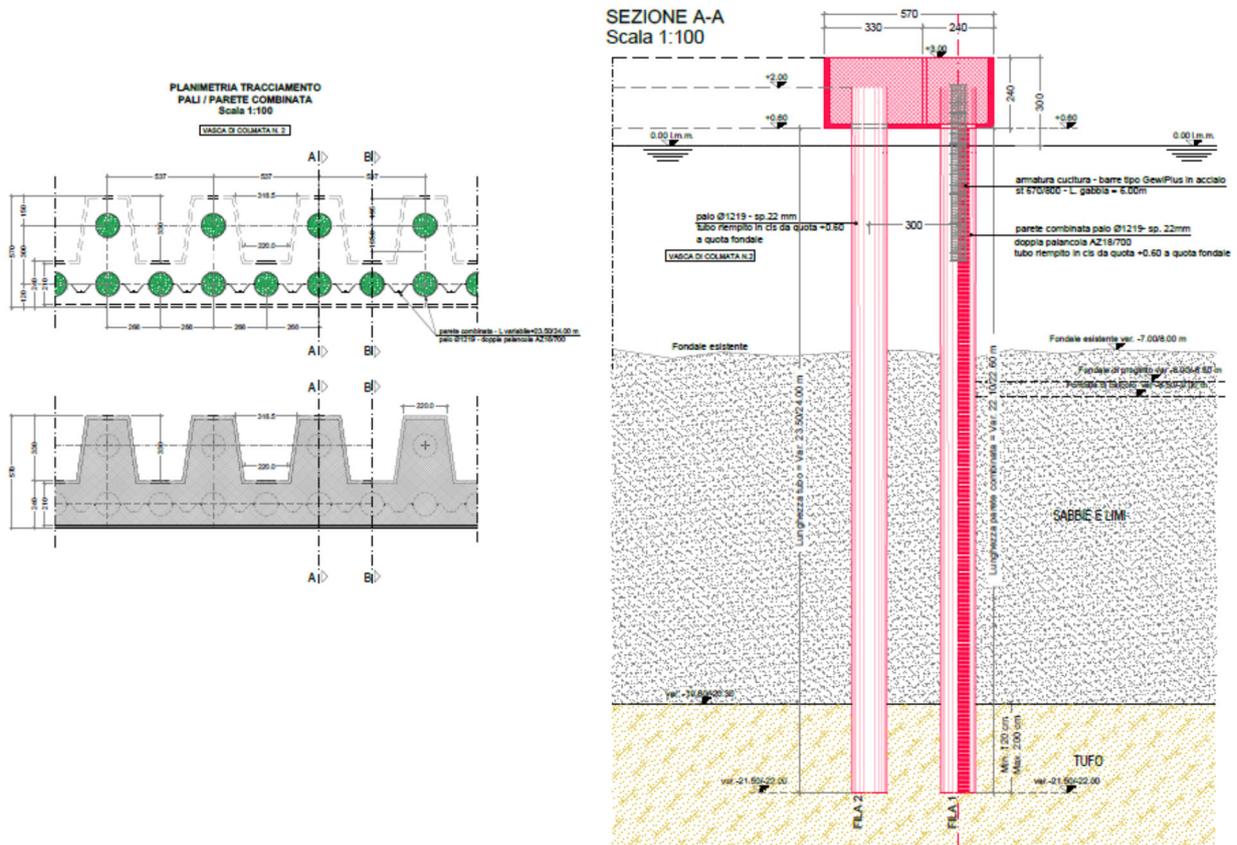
Sezione tipologica di progetto tratto A (stralcio elaborato MI061P-PDDS4022 - Progetto cassa di colmata – Sezioni)
